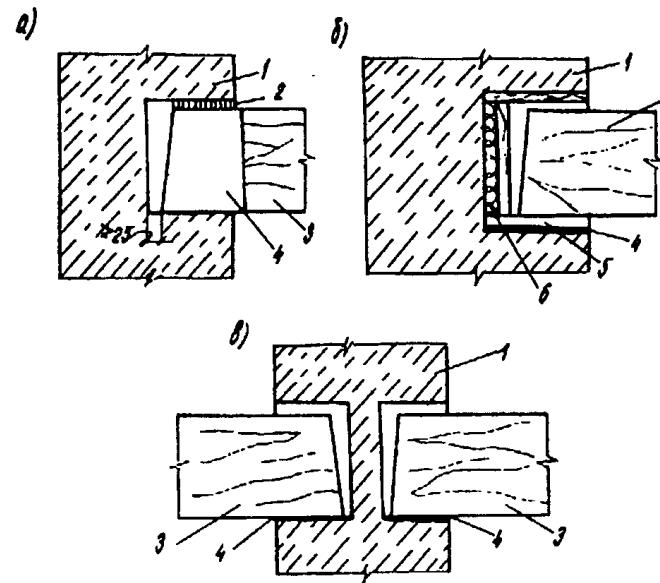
Схемы узлов опирания деревянных балок на кирпичные стены (а — наружные при толщине 51 см и менее; б — наружные при толщине более 51 см; в — внутренние):
